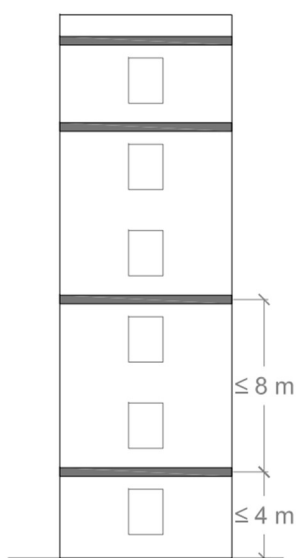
9 Barreras cortafuego en fachadas con acabado tipo SATE
